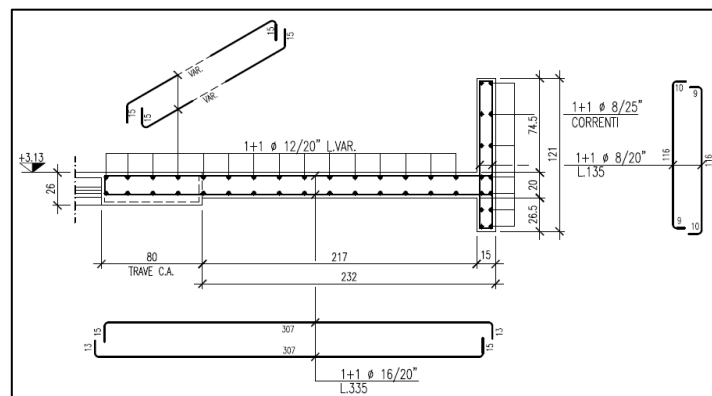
Sezione corrente della soletta piena a sbalzo in calcestruzzo armato del 1° piano
